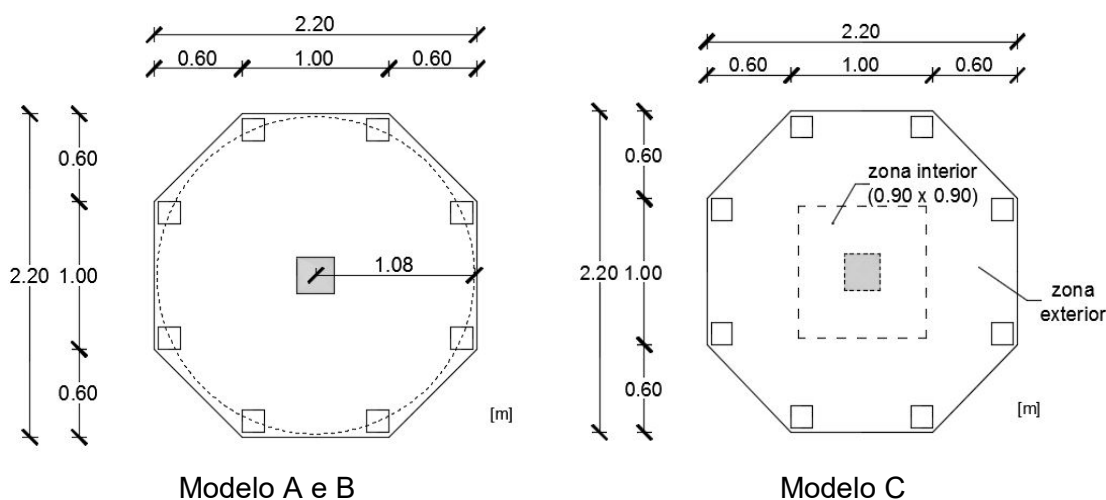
Planta do ensaio das lajes hexagonais (adaptado de [8])
